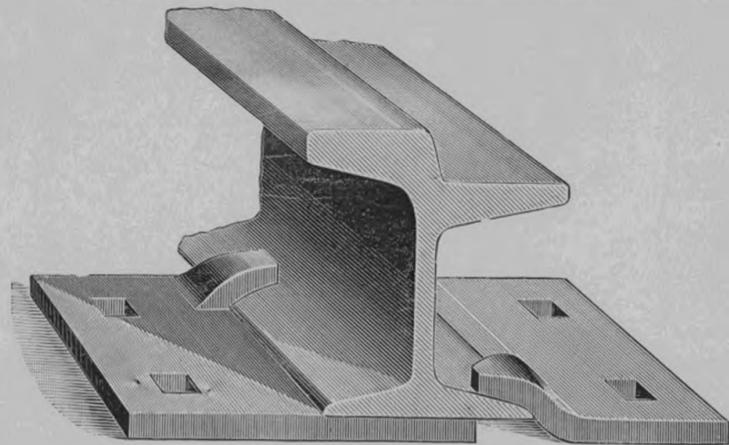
RAIL DE TRAMWAY A SELLE D'ATTACHE SUR LES TRAVERSES POUR POSE DANS UNE CHAUSSÉE ORDINAIRE
